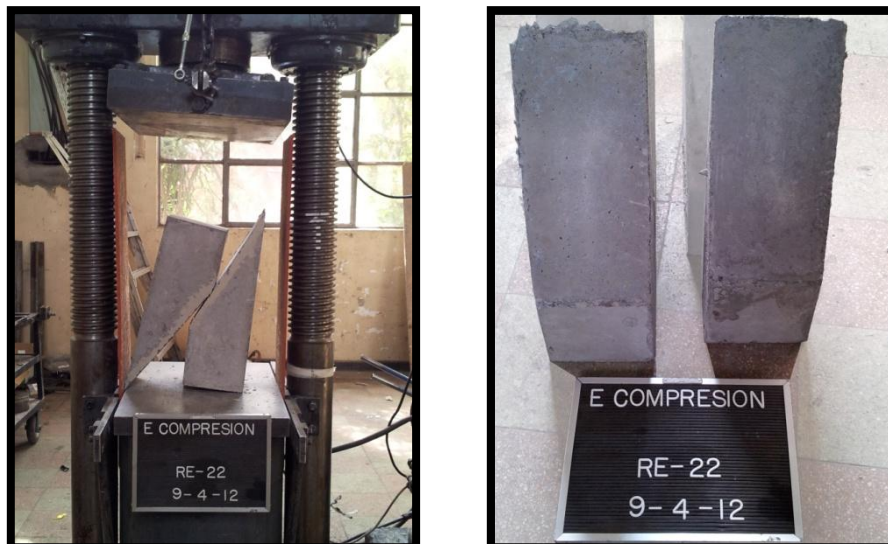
2: Falla típica prismas fabricados con hormigón de pavimento y junta moldeada con puente de adherencia.
